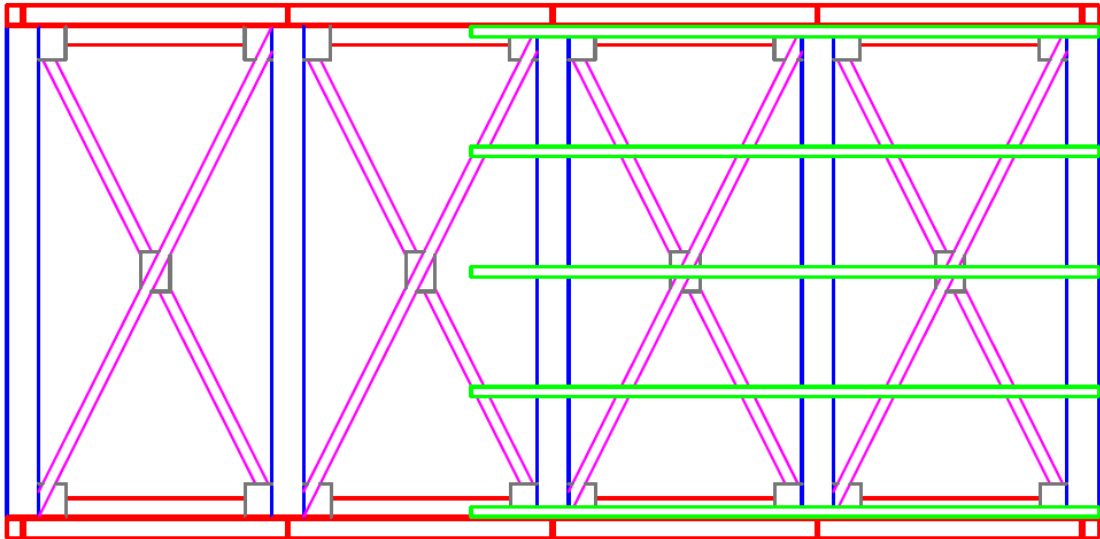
Vista en planta de l'estructura d'acer on es detallen els perfils.
